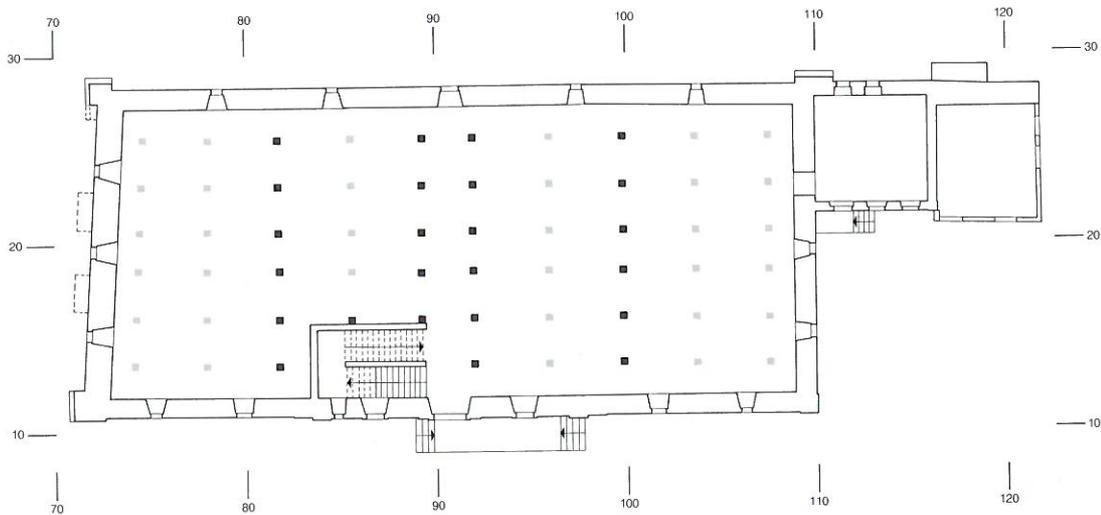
Grundriss des Kornhauses mit dem an die Korndarre angebauten Wohnhaus des frühen 19. Jahrhunderts. Schwarz: erhaltene Holzständer. Grau: rekonstruierte Standorte von Holzständern, welche beim Umbau von 1837 entfernt worden waren.
